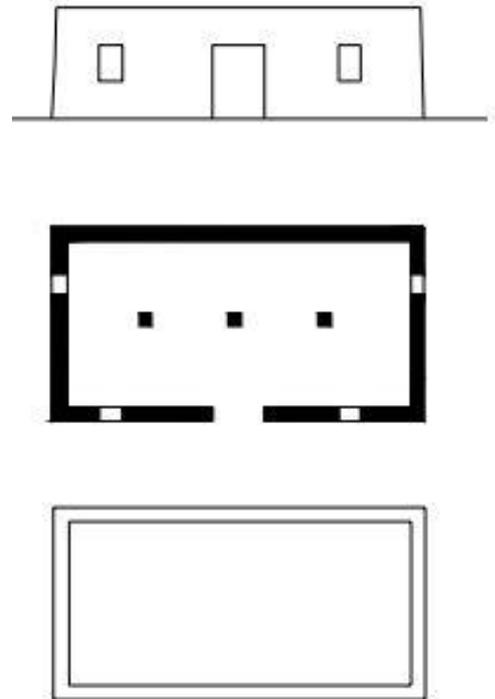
Alzado, planta y cubierta vivienda elemental
